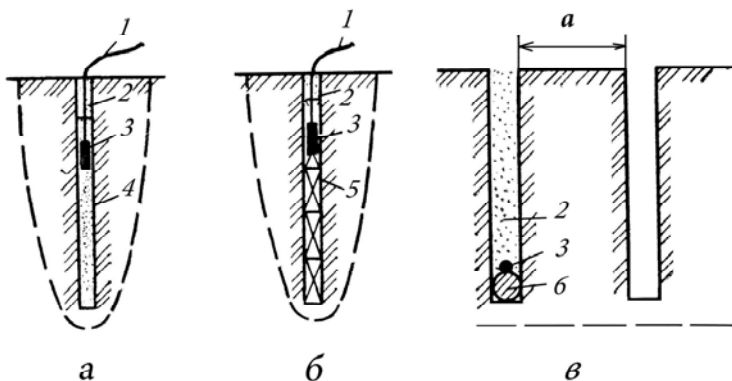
Схемы взрывомеханического способа разрушения грунта и скальных пород:
